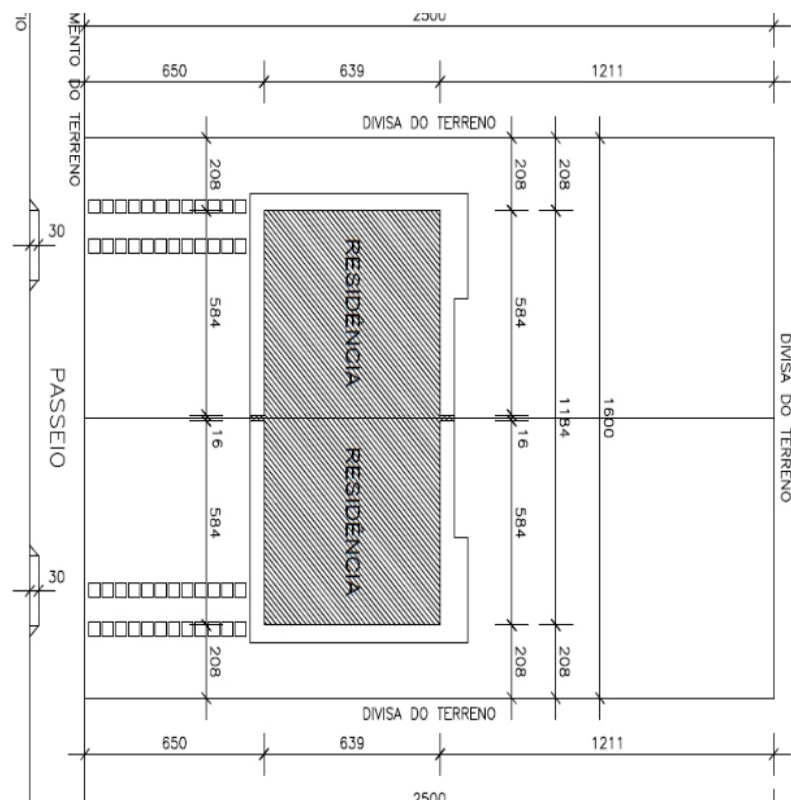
Planta de locação. Fonte: Construtora Marca Registrada, 2019.
